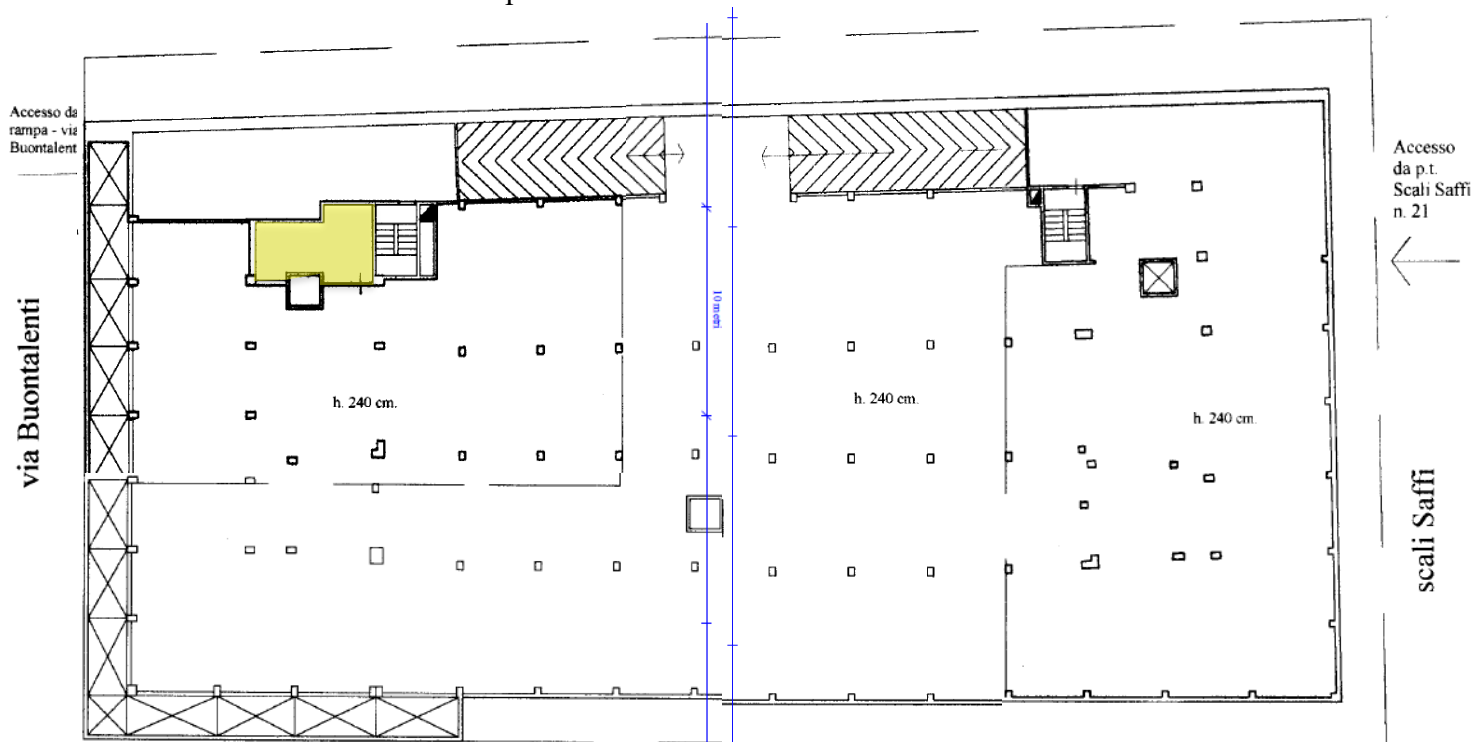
Estratto della planimetria catastale del magazzino posto al piano primo interrato S2
